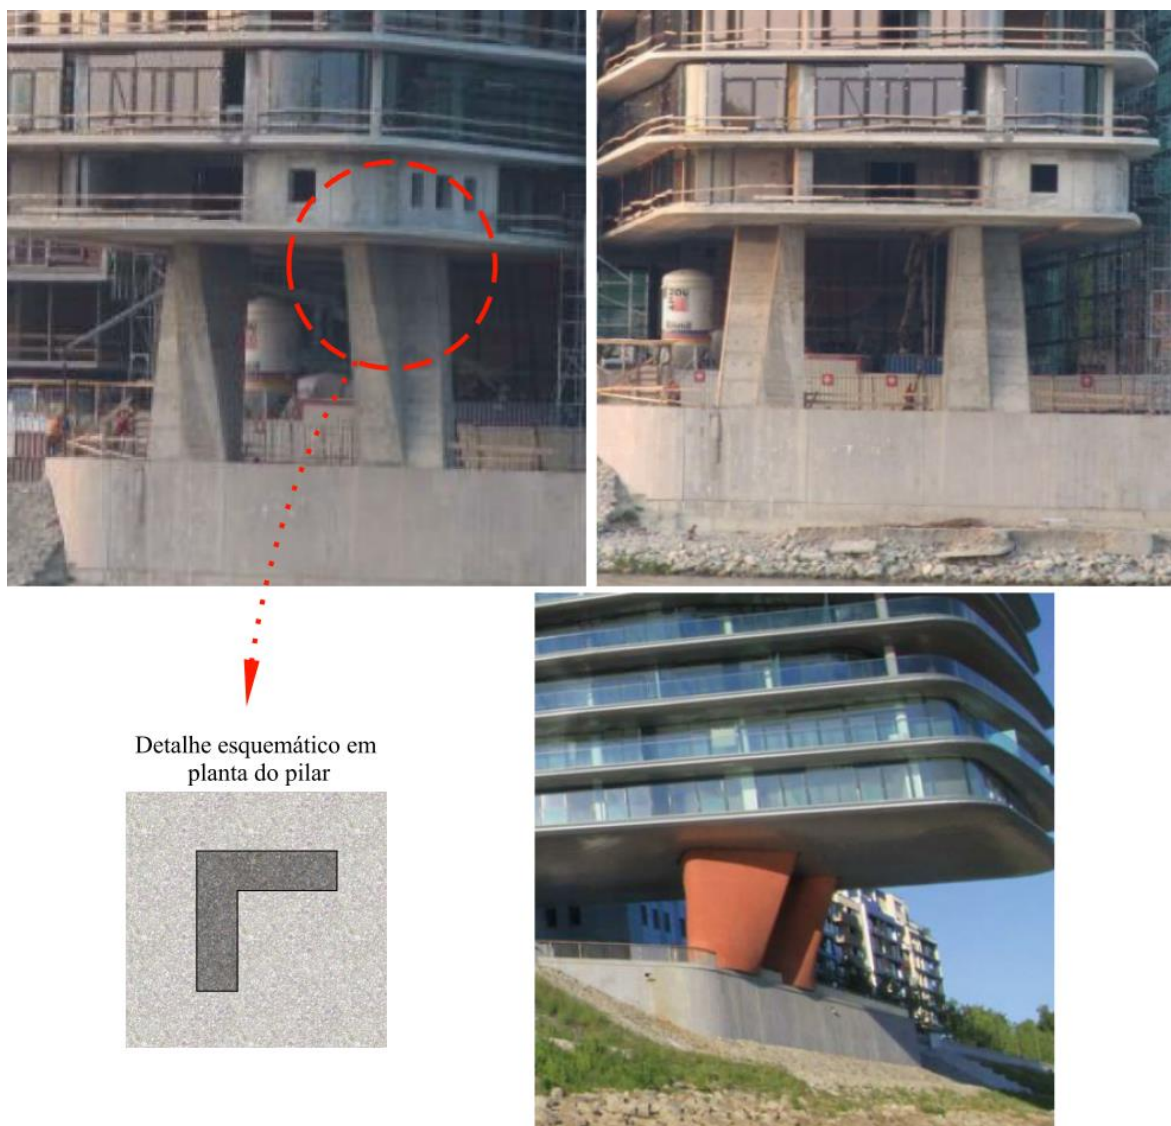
Edifício River House em Bratislava, Eslováquia
